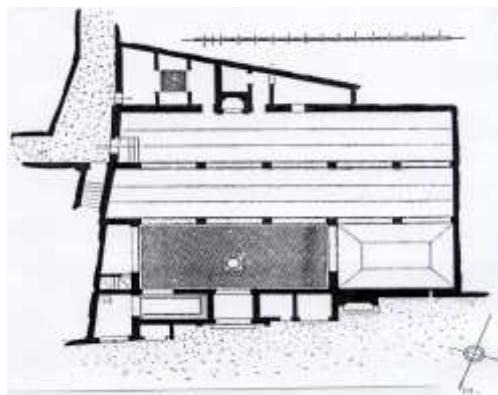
مسقط أفقى لجامع أبي العباس السبتي بمراكش
